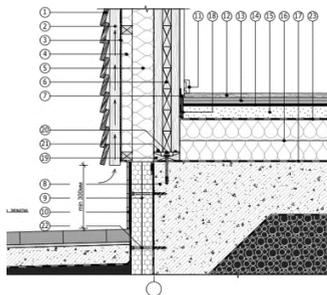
Пример примыкания CLT-панели к бетонному основанию
